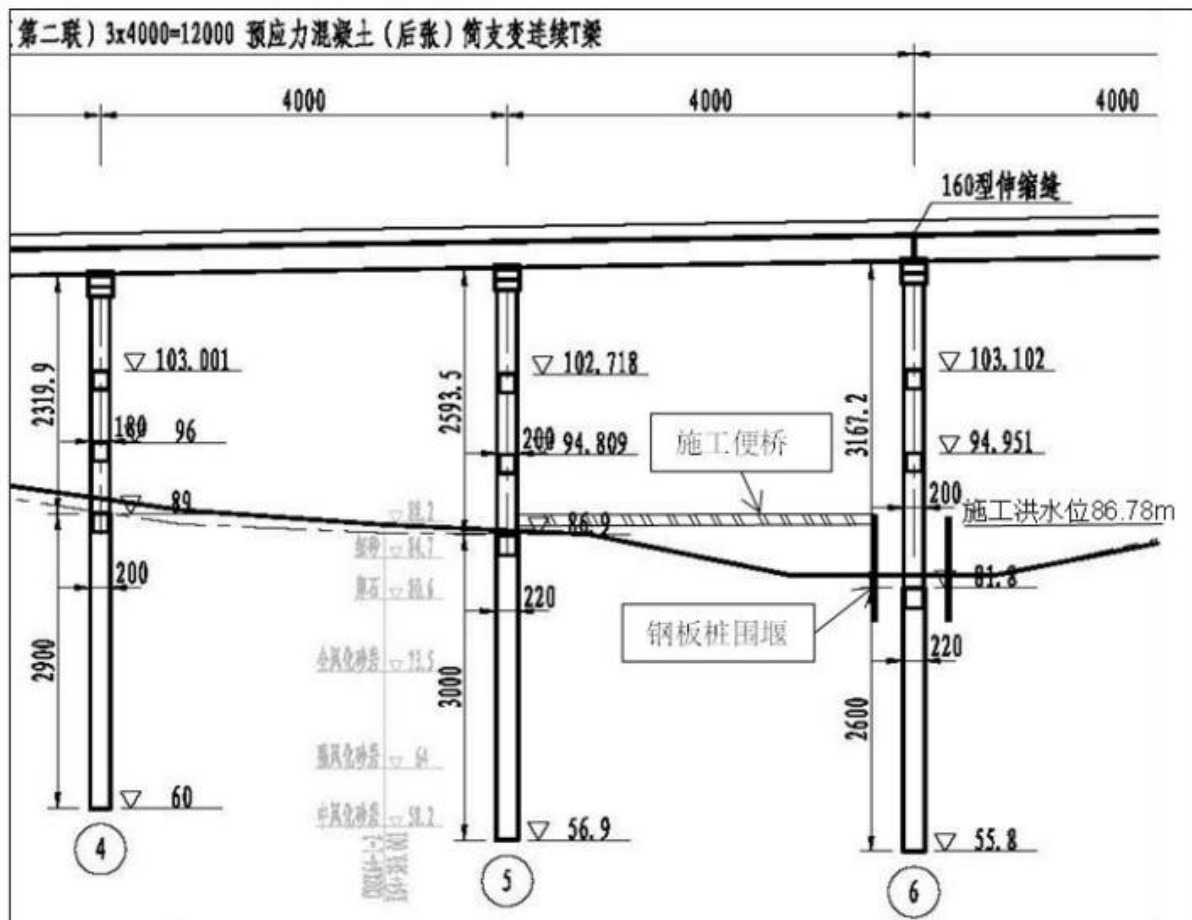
思务泗罗江大桥 6#桥墩钢板桩围堰施工剖面图
